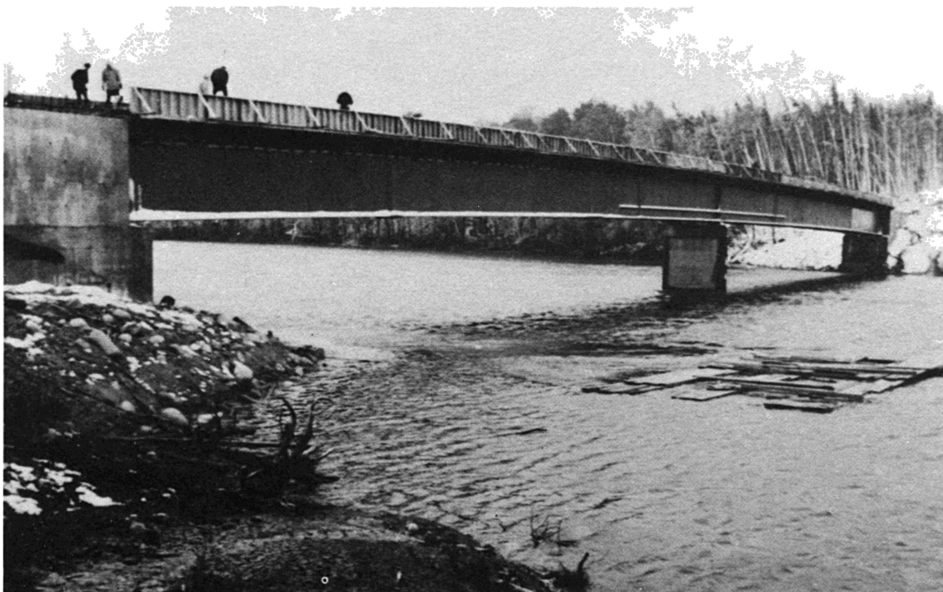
Pont sur poutres d'acier avec culées. pilier et tablier en bois
